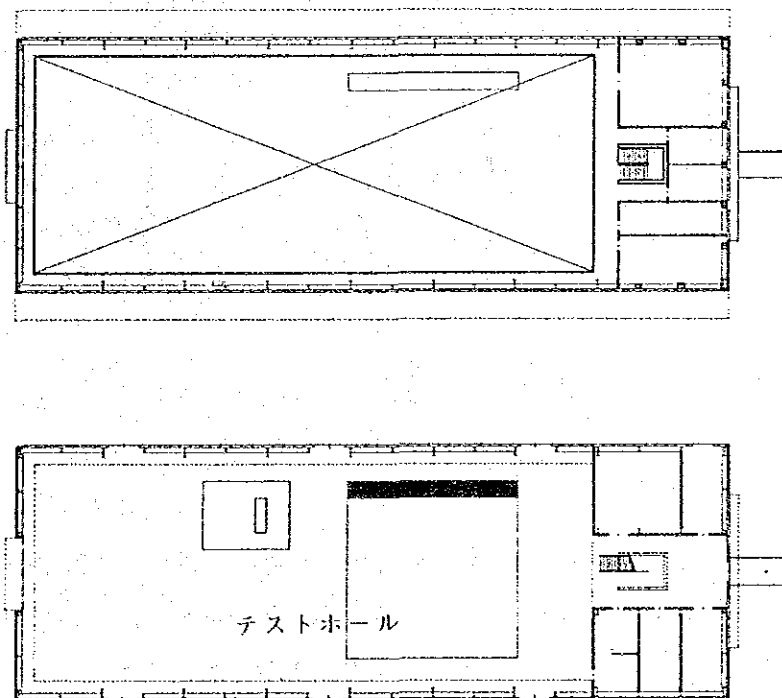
構造耐震実験棟計画平面図 (1階、2階)
